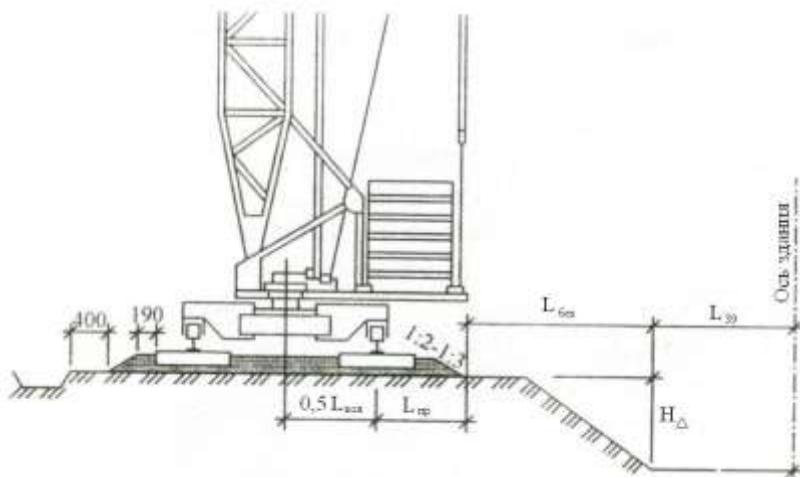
Установка башенного крана у неукрепленного откоса котлована
